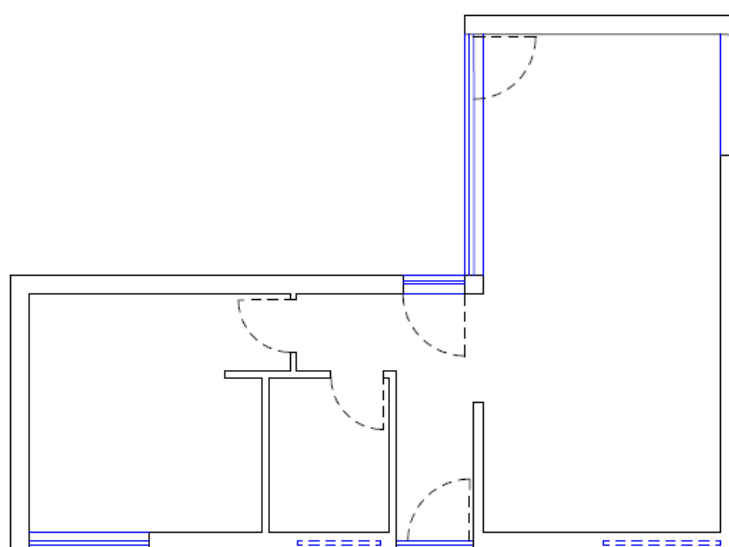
Planta do modelo T1 do ICFs e construção tradicional
